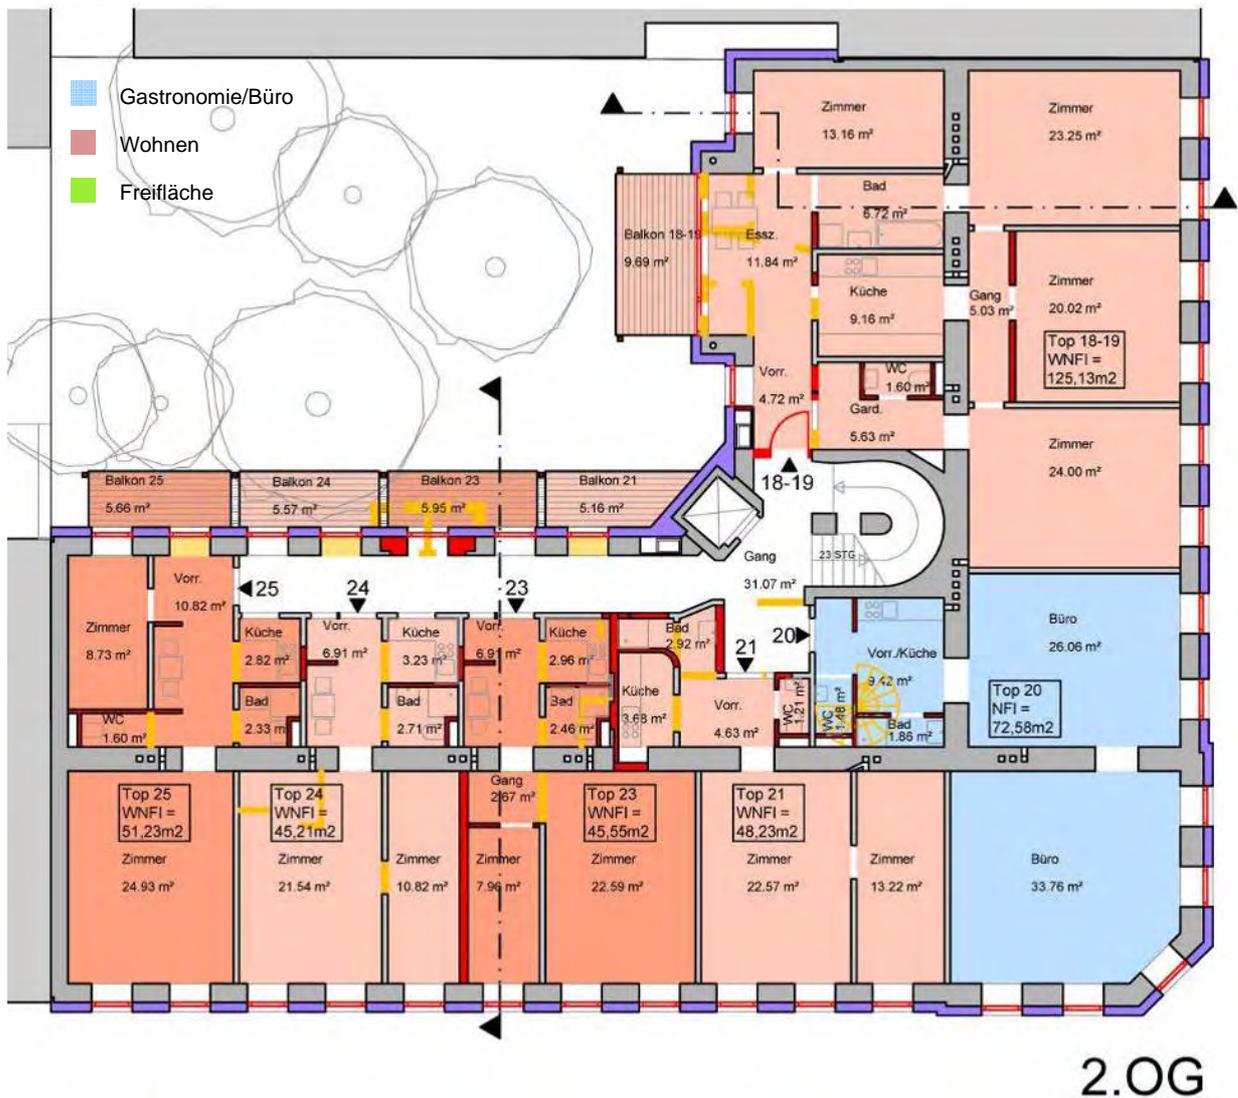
Grundriss 2. Obergeschoß
